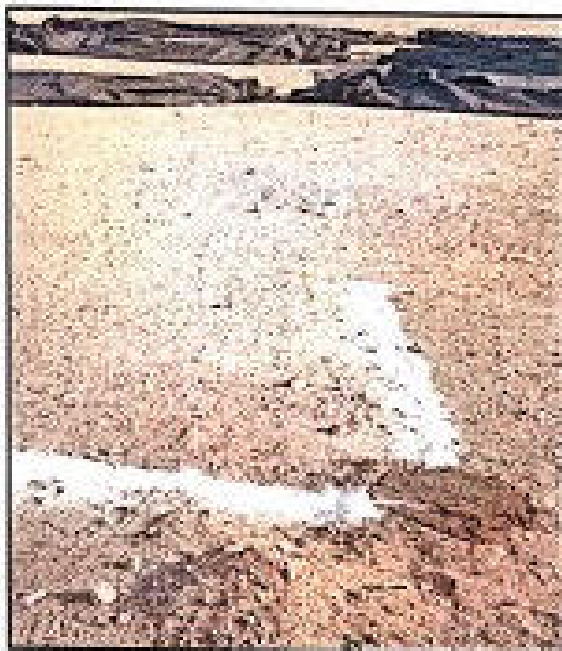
Vista del vértice de esquina en tubo con concreto y varilla de 3/8".
